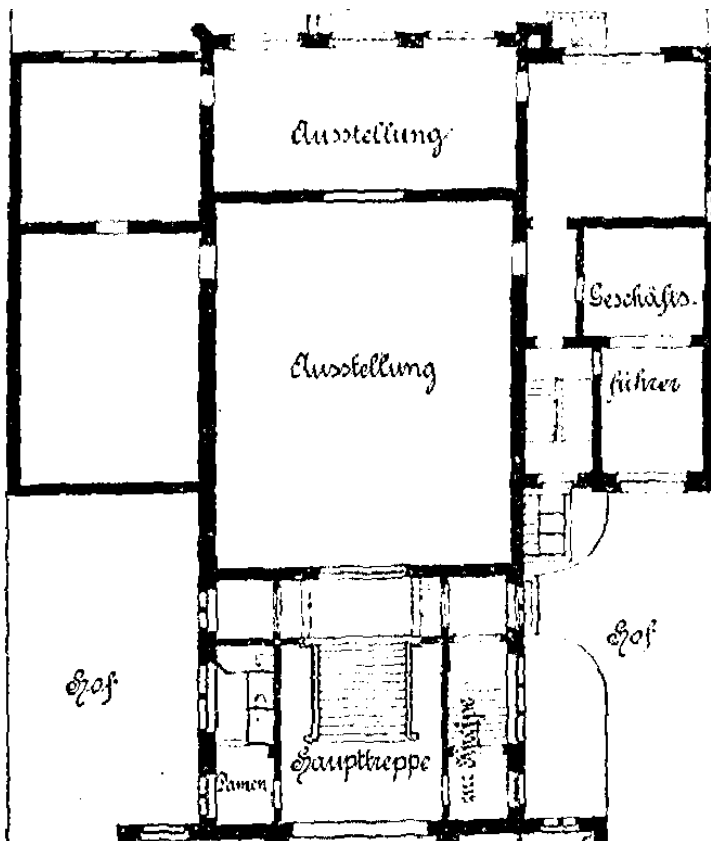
Grundriss der Ausstellungsräume, Künstlerhaus Berlin 1898
